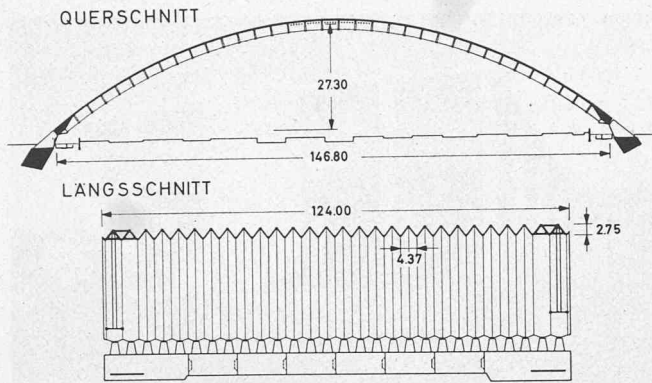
Paketumschlaghalle München, Längs- und Querschnitt
